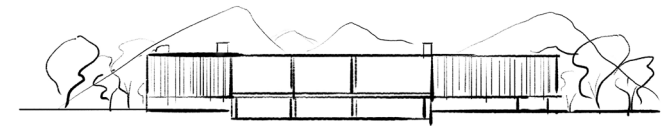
Boceto de un alzado de la Resor House en el Snake River Ranch
